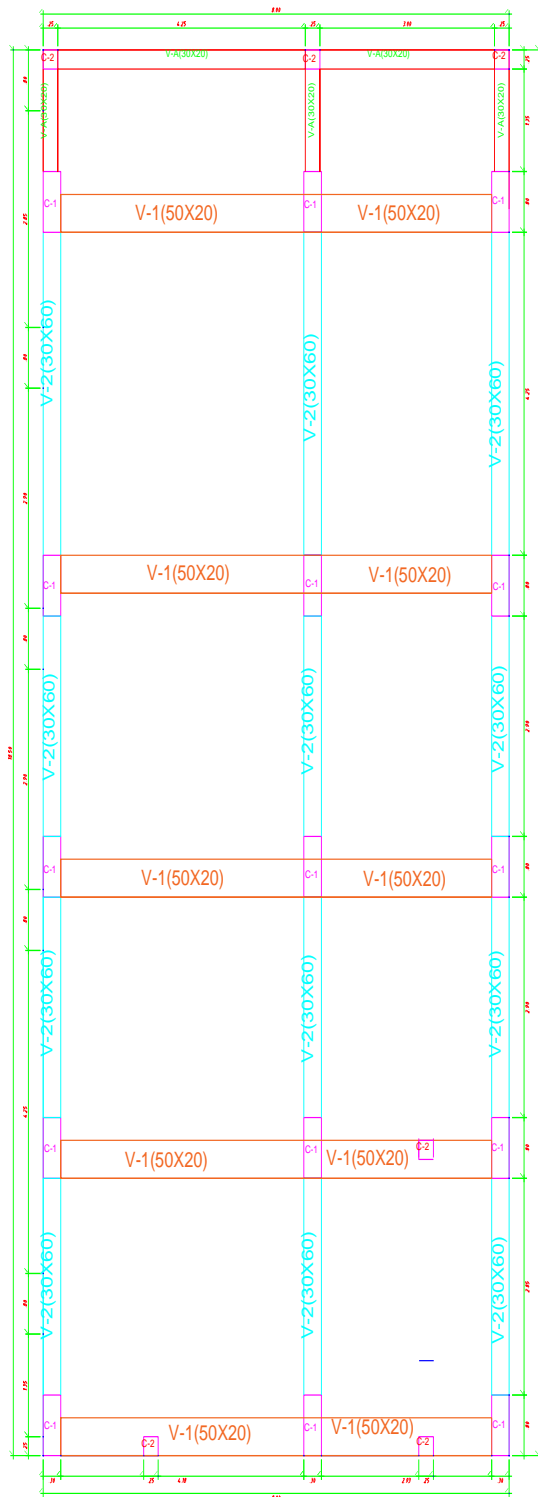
plano 2d visto en planta(AutoCAD) E-01
